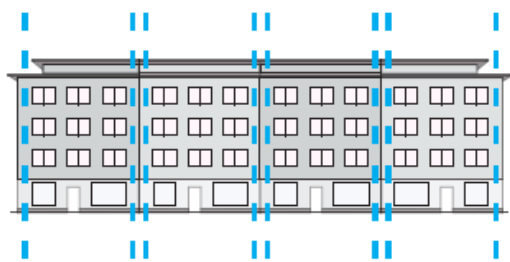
seitliche Wandpfeiler gliedern Fassade und bilden kleinteilige Parzellierung ab
